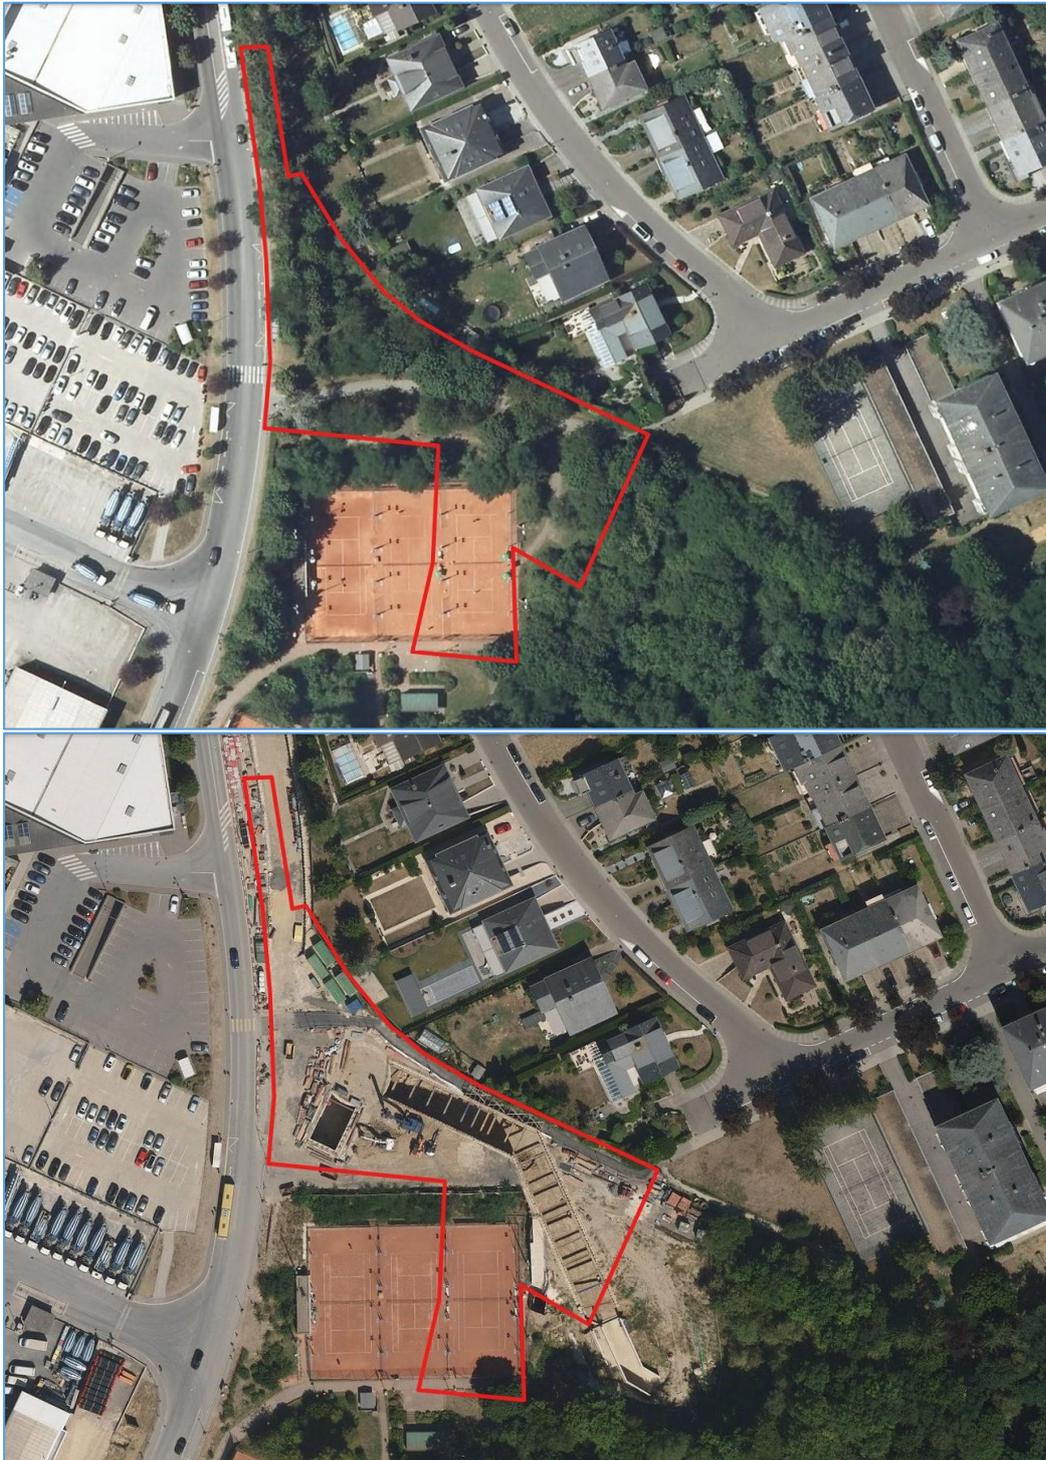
Parkwald (Orthofoto 2019) oben und Baustelle (Orthofoto 2022) unten - geoportail.lu
